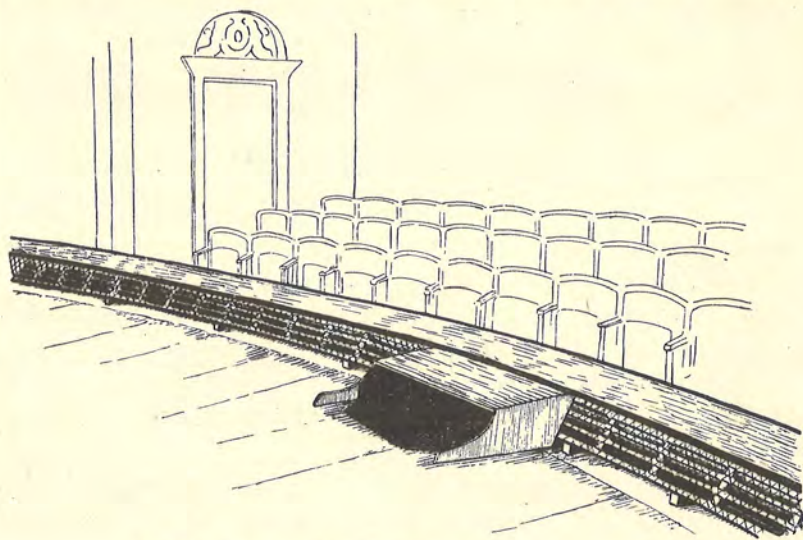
Einbau einer Fußrampe mit direkt wirkenden Röhrenlampen.
